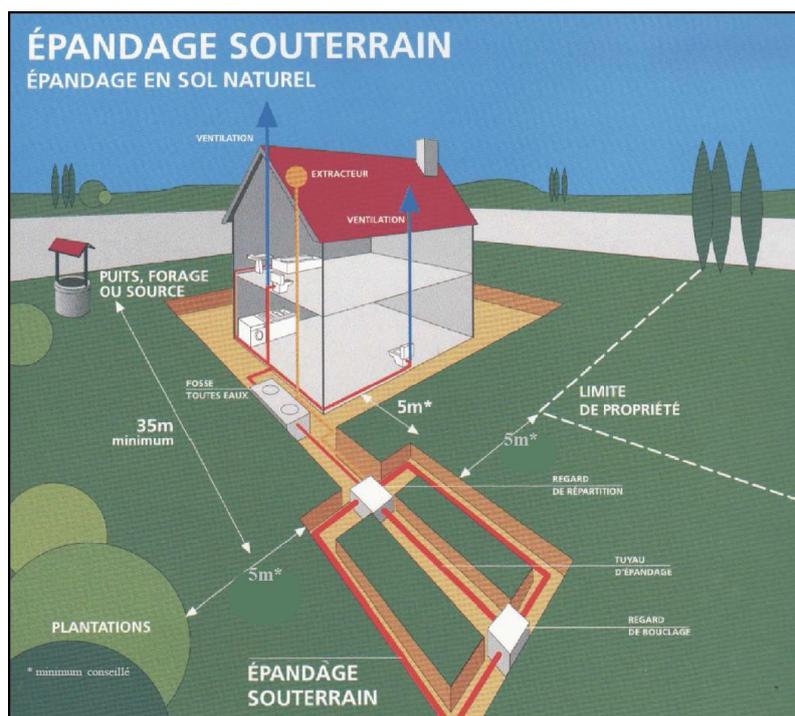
Schéma d'un dispositif d'assainissement non collectif (source : Agence de l'eau)
